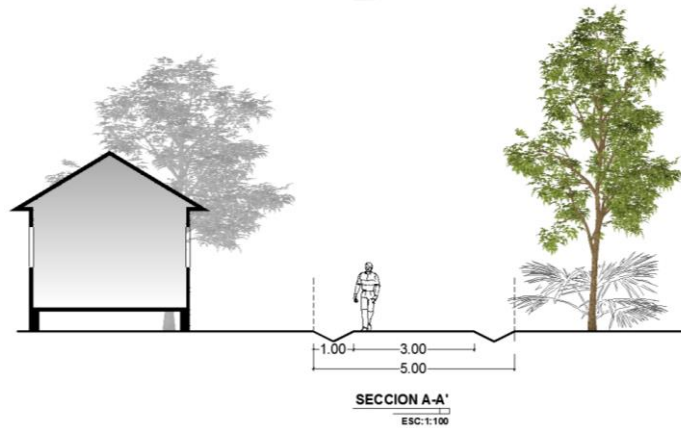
SECCION VIAL DEL BARRIO SAN JUAN
